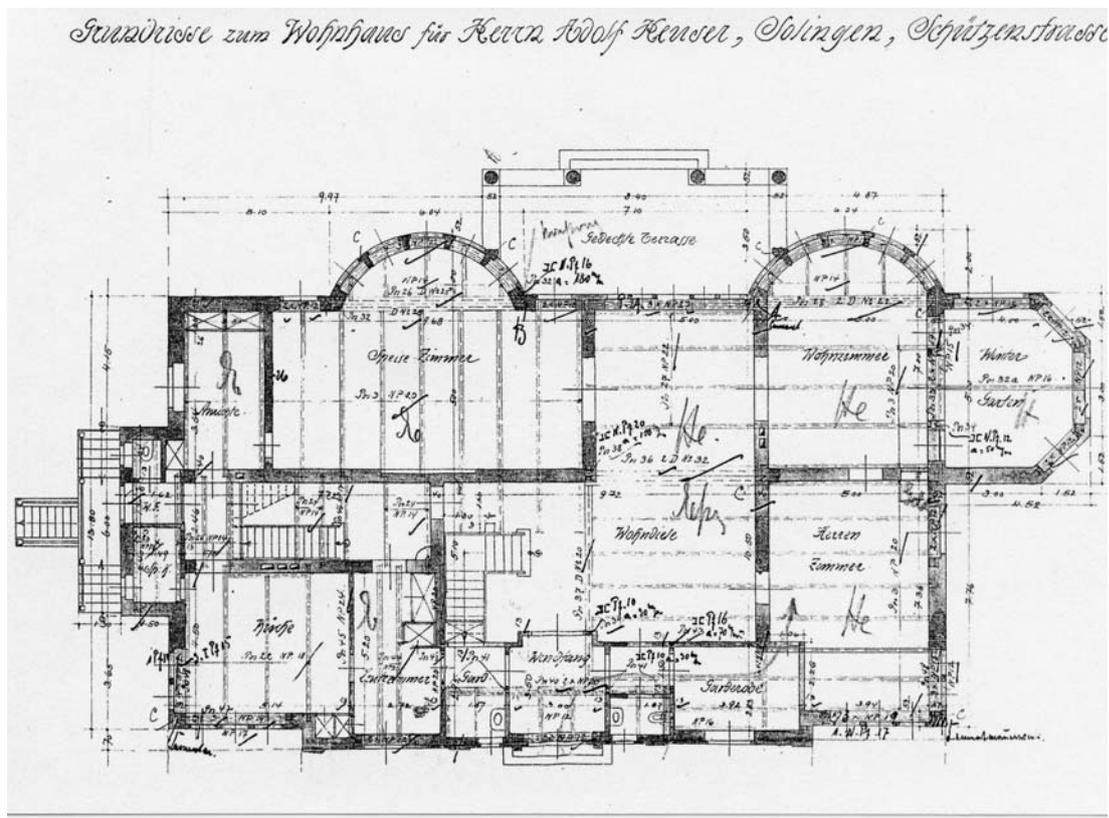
H. Plenge, Grundriss Erdgeschoss, 1913
